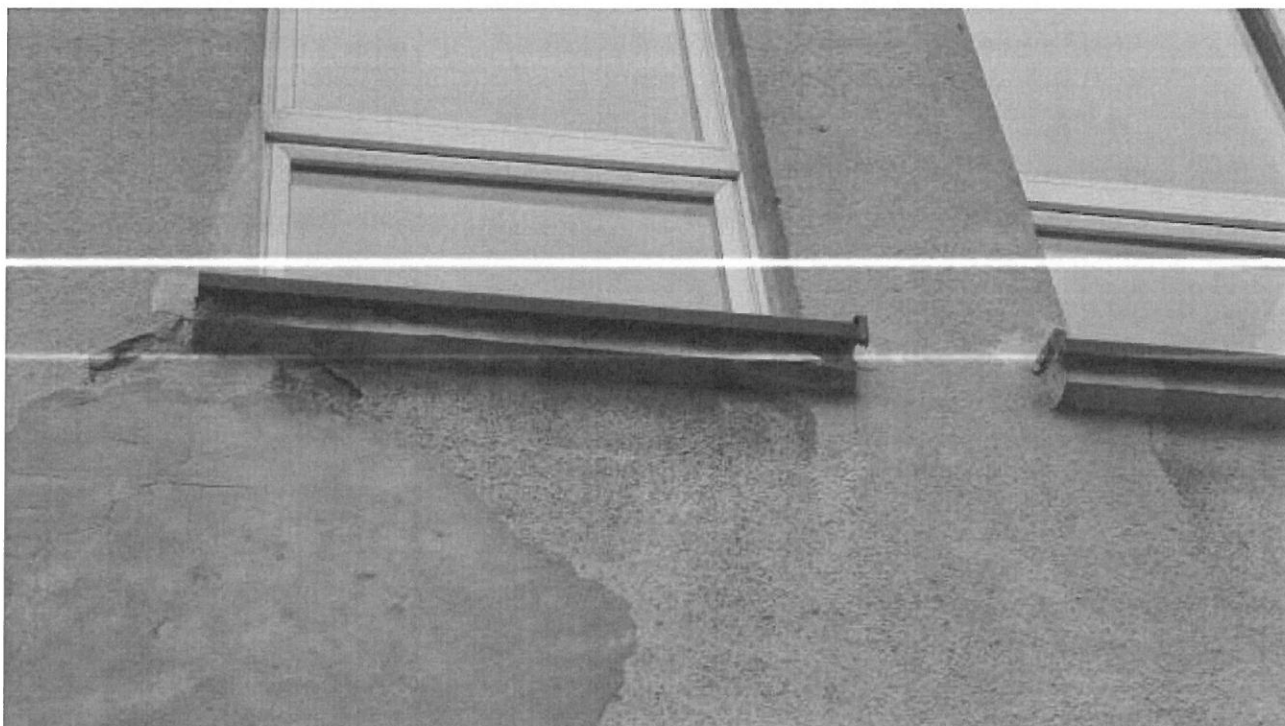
W wolnych przestrzeniach pod parapetami mogą znajdować się niewielkie kolonie nietoperzy karlików.
